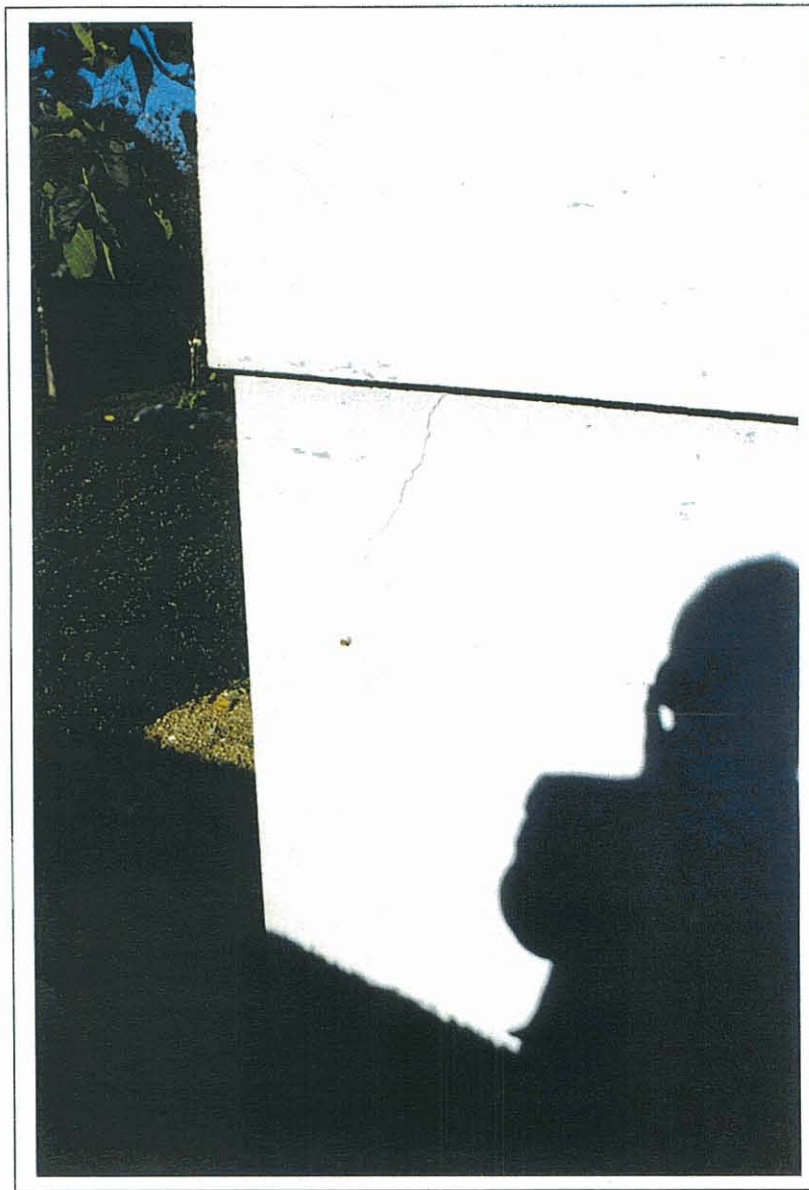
Fissuration verticale à l'angle ouest.
